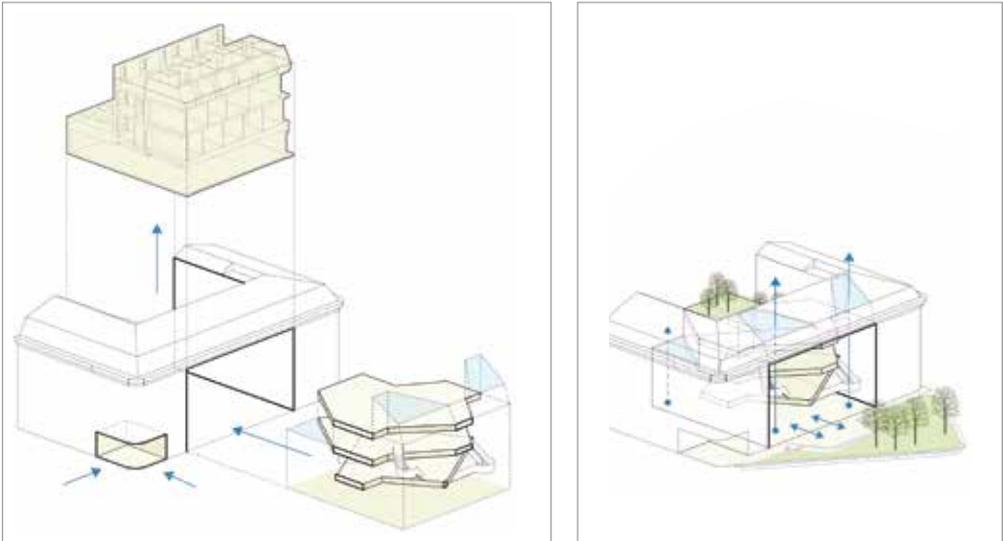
the next ENTERprise architects, drei Interventionen am ehemaligen Kanzleigebäude
